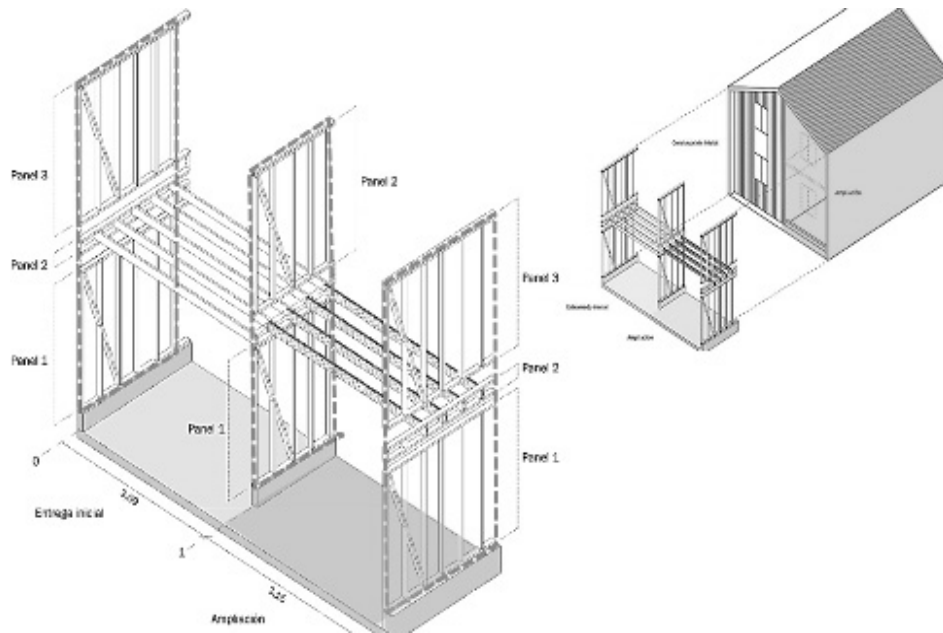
Villa Verde, Ensamblaje (Plataforma Arquitectura, 2007)
